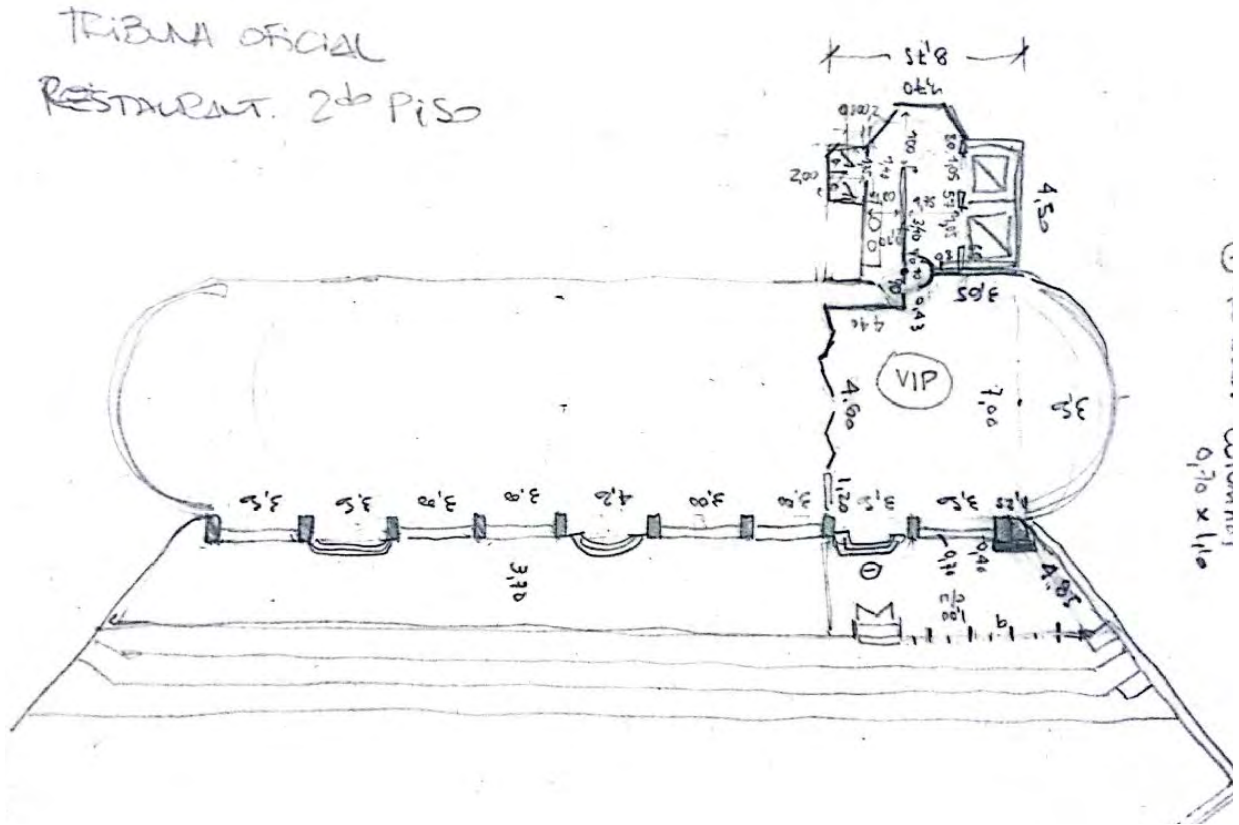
Plano Tribuna Oficial. Planta 2do piso. Confeccionado a partir del relevamiento realizado.
